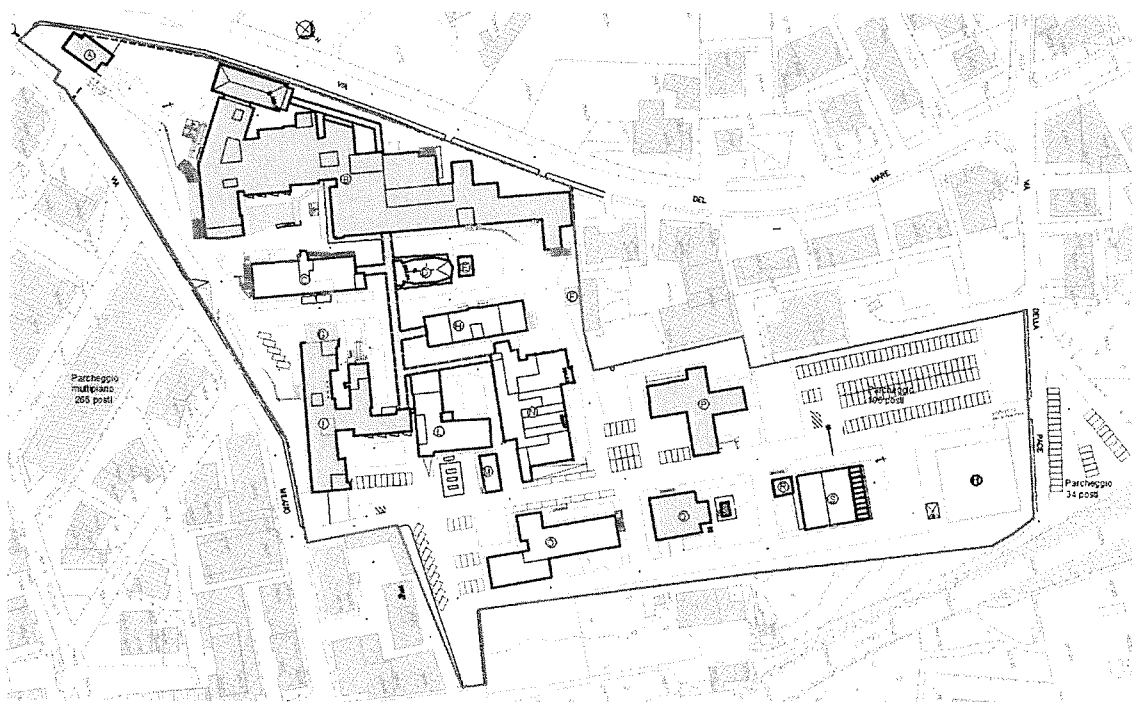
planimetria stato attuale con evidenza degli edifici oggetto di demolizione
